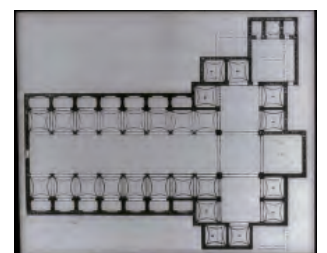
Planta de la Iglesia de San Lorenzo, Brunelleschi. Fuente: internet
